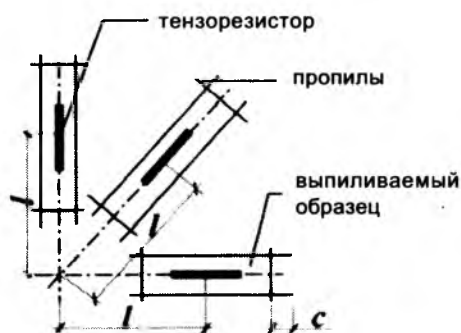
Схема наклейки тензорезисторов на конструкцию
